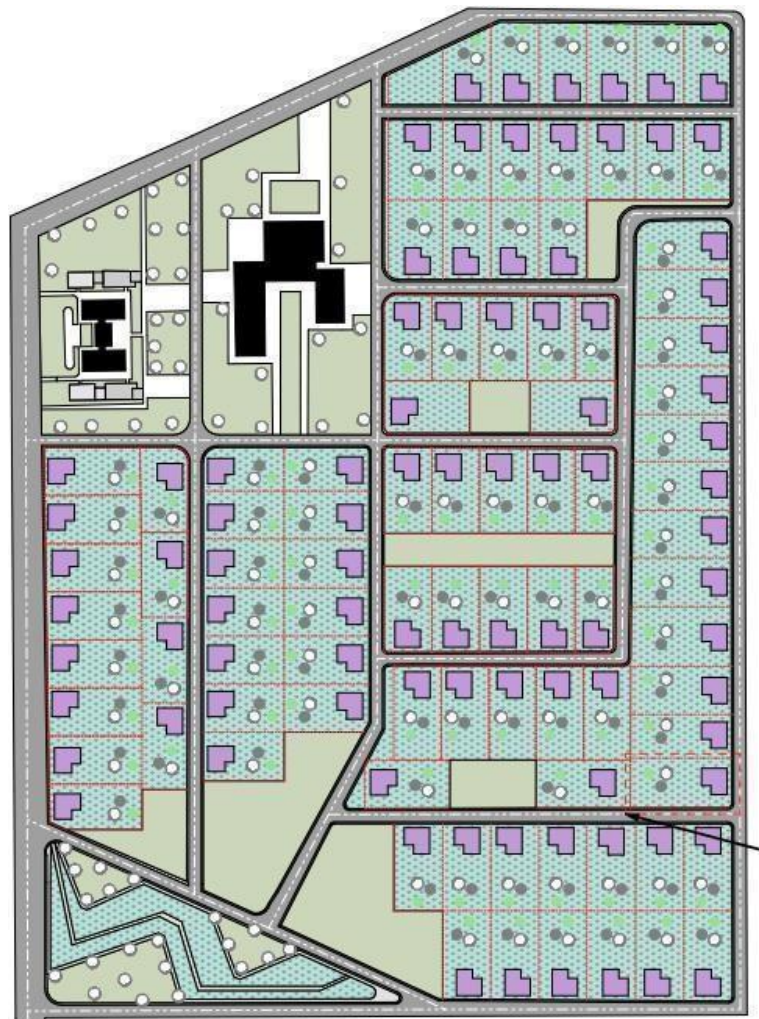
Генеральний план житлового кварталу у м. Ужгород
